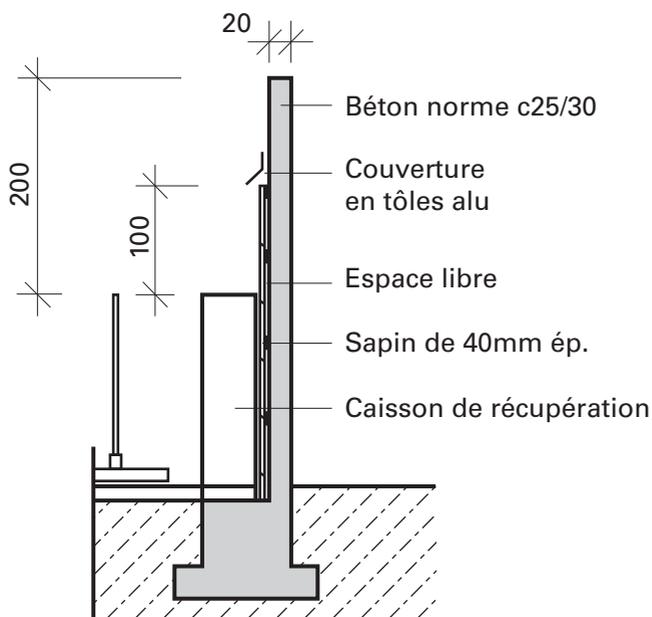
Coupe en travers d'une butte pare-balles artificielle à 25 m
